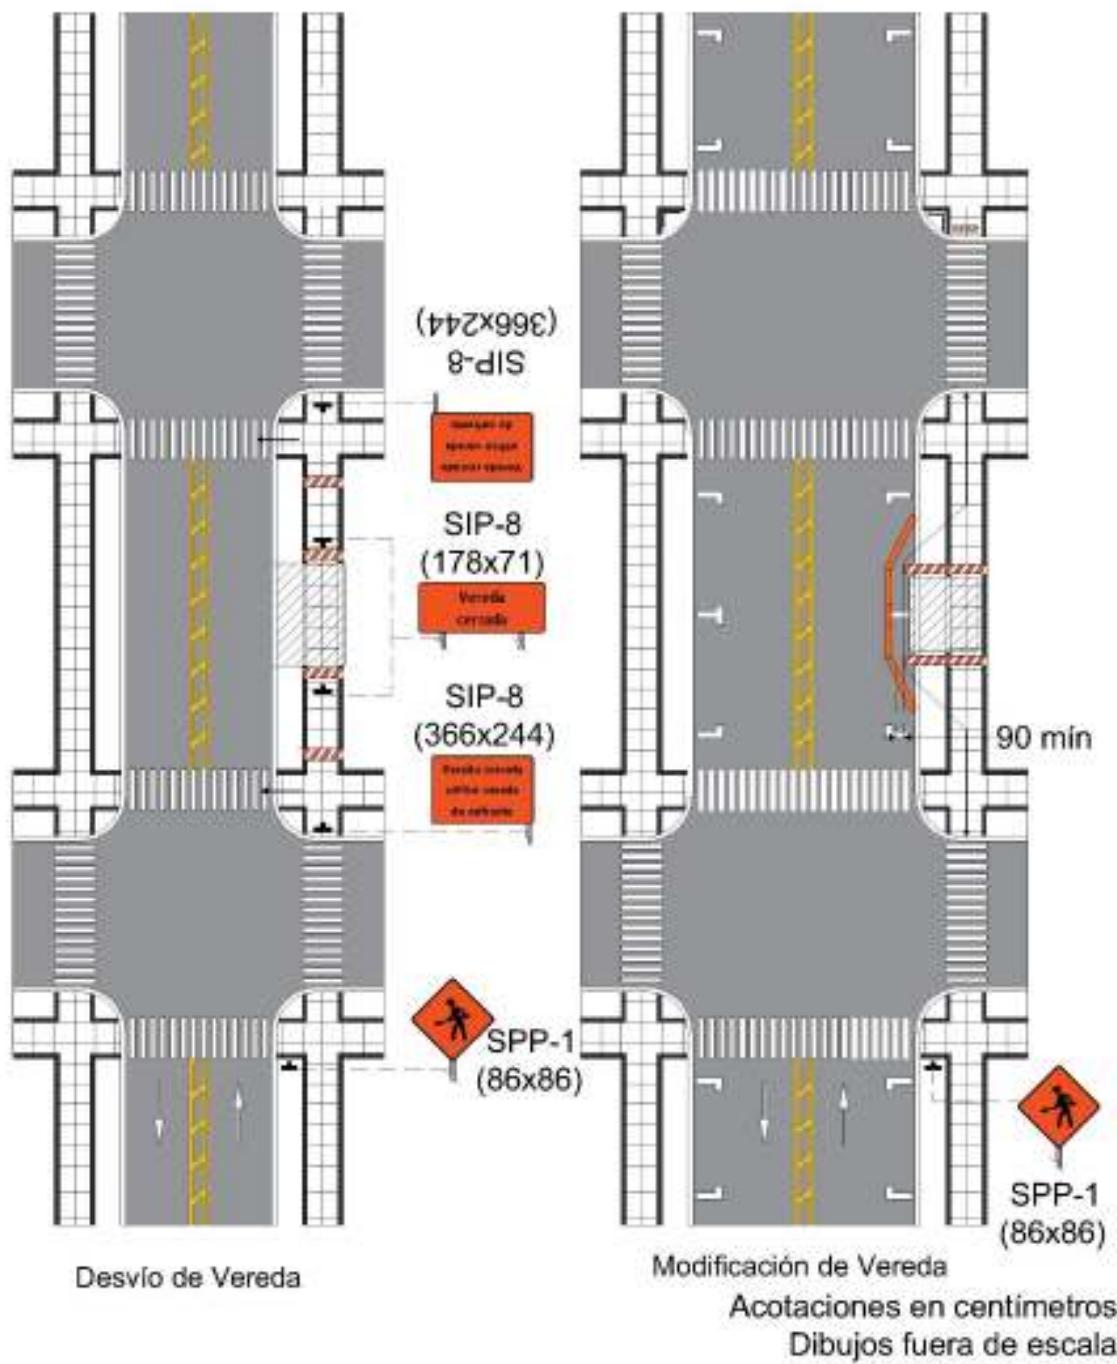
Derivación o desvío de banqueta (Vía con ancho de arroyo vial menor a 9 m)
